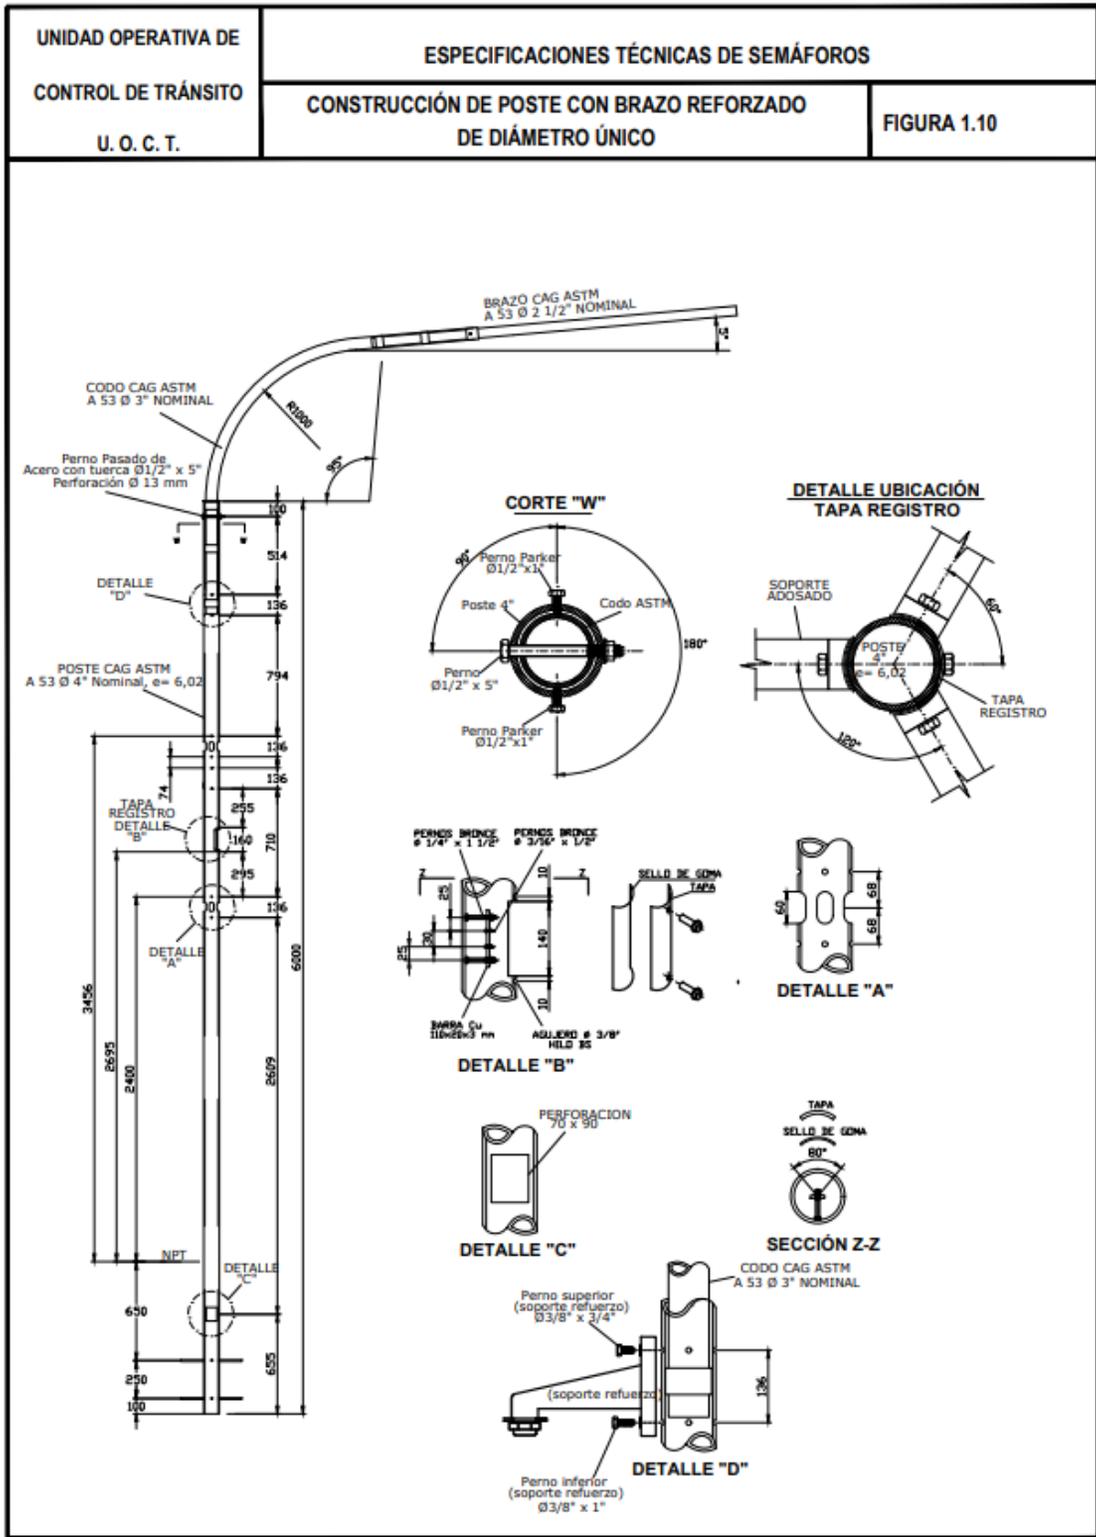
Construcción de poste con brazo reforzado de diámetro único
